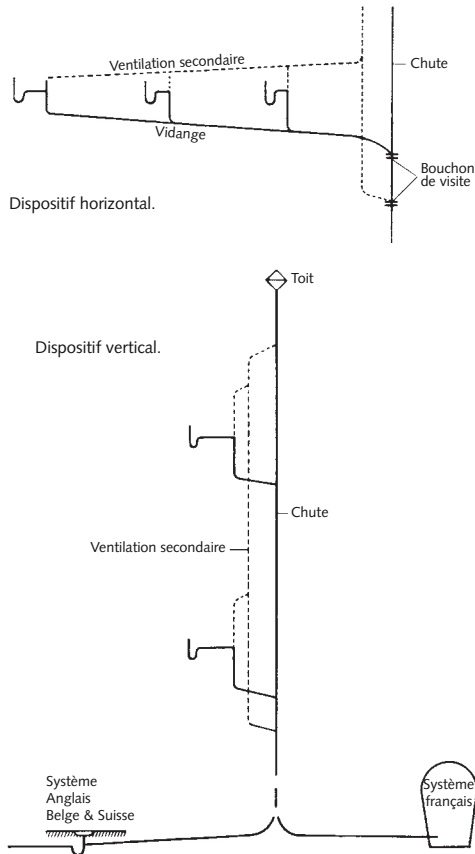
Schéma de principe d'une ventilation secondaire
